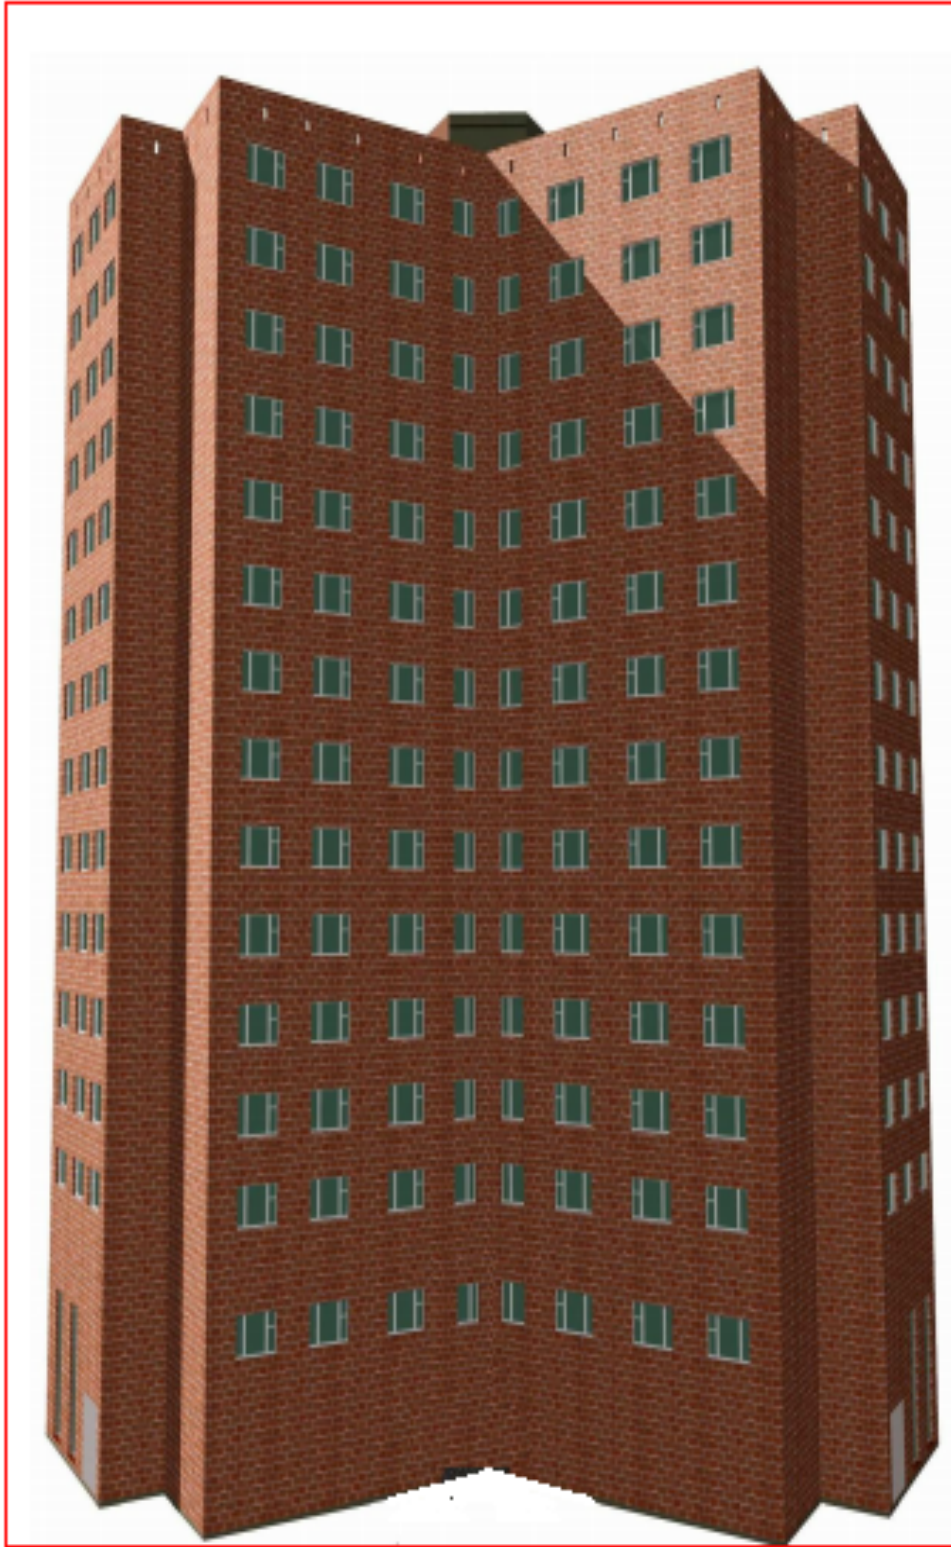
Фасад будівлі готелю у вісях 1 – 9
